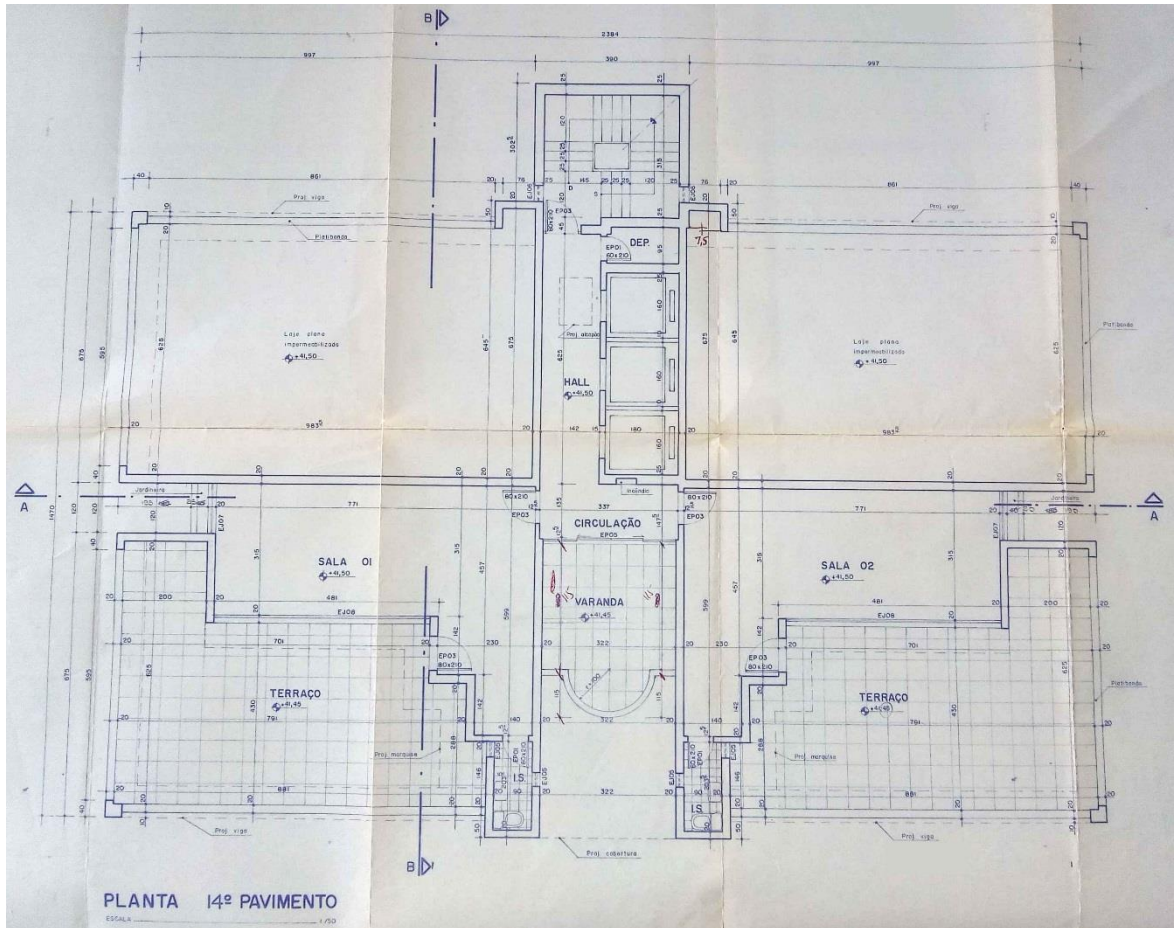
Planta do 14º pavimento (piso da cobertura).
